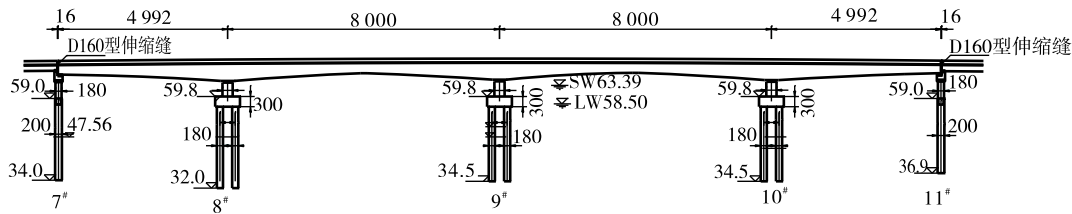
主桥立面图(单位:标高为 m,其他为 cm)
